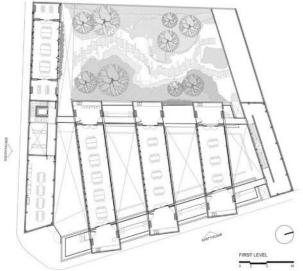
Planta Primer Nivel de CCD "Los Chocolates", Archdaily. Fotografías: Rafael Gamo y Jaime Navarro
